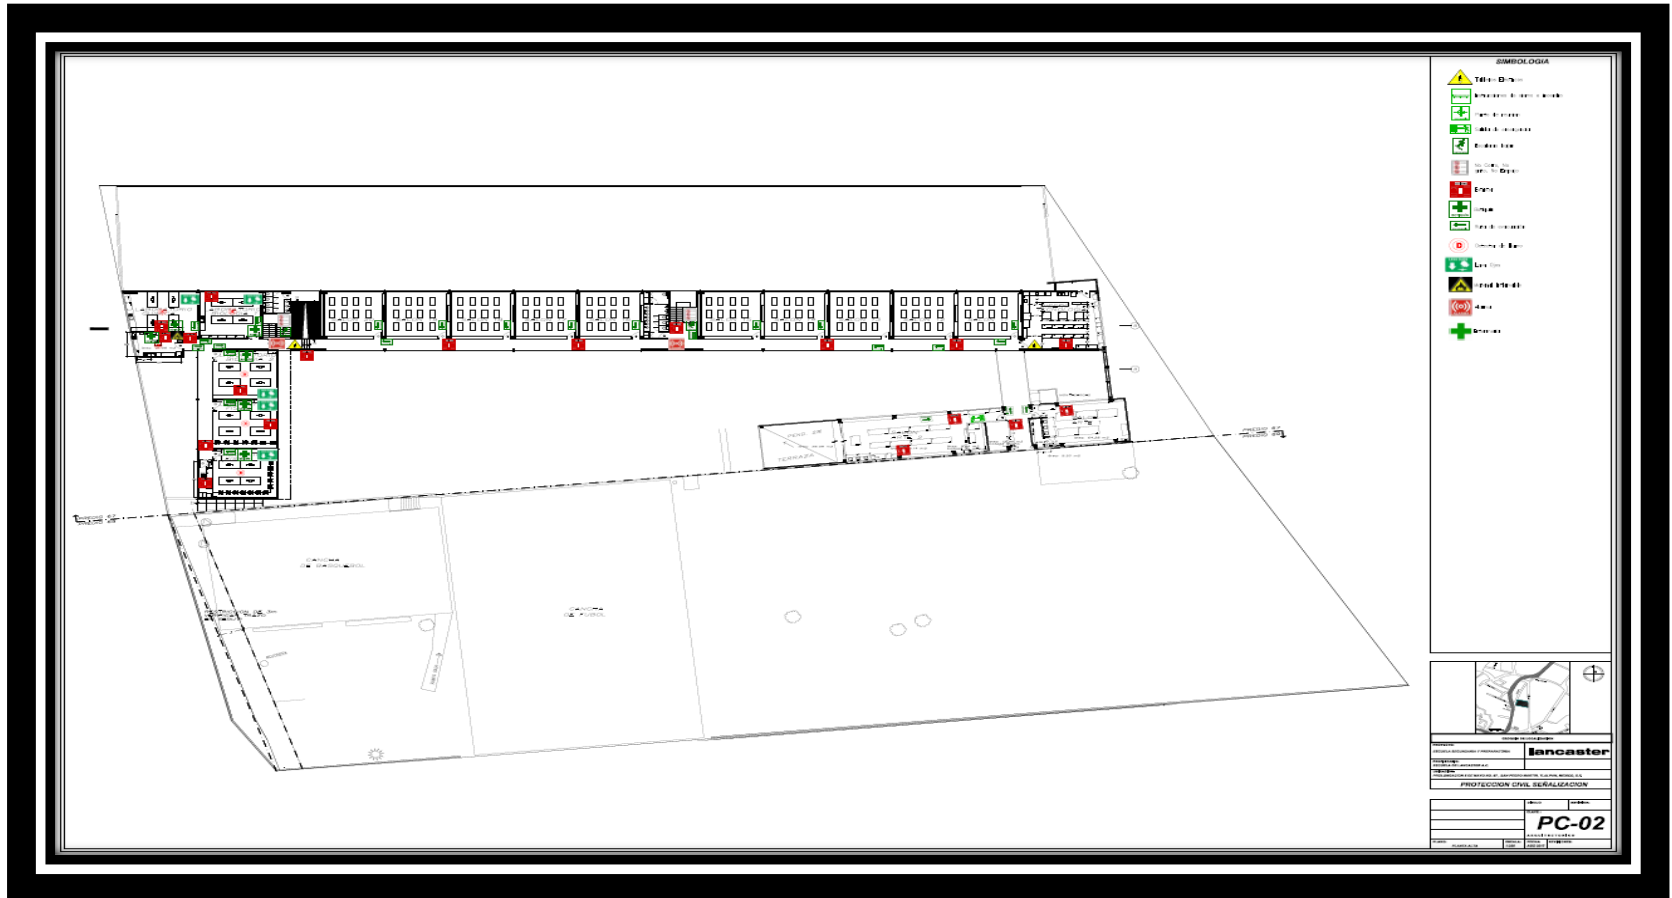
Croquis del Plantel de Diligencias, planta baja.
